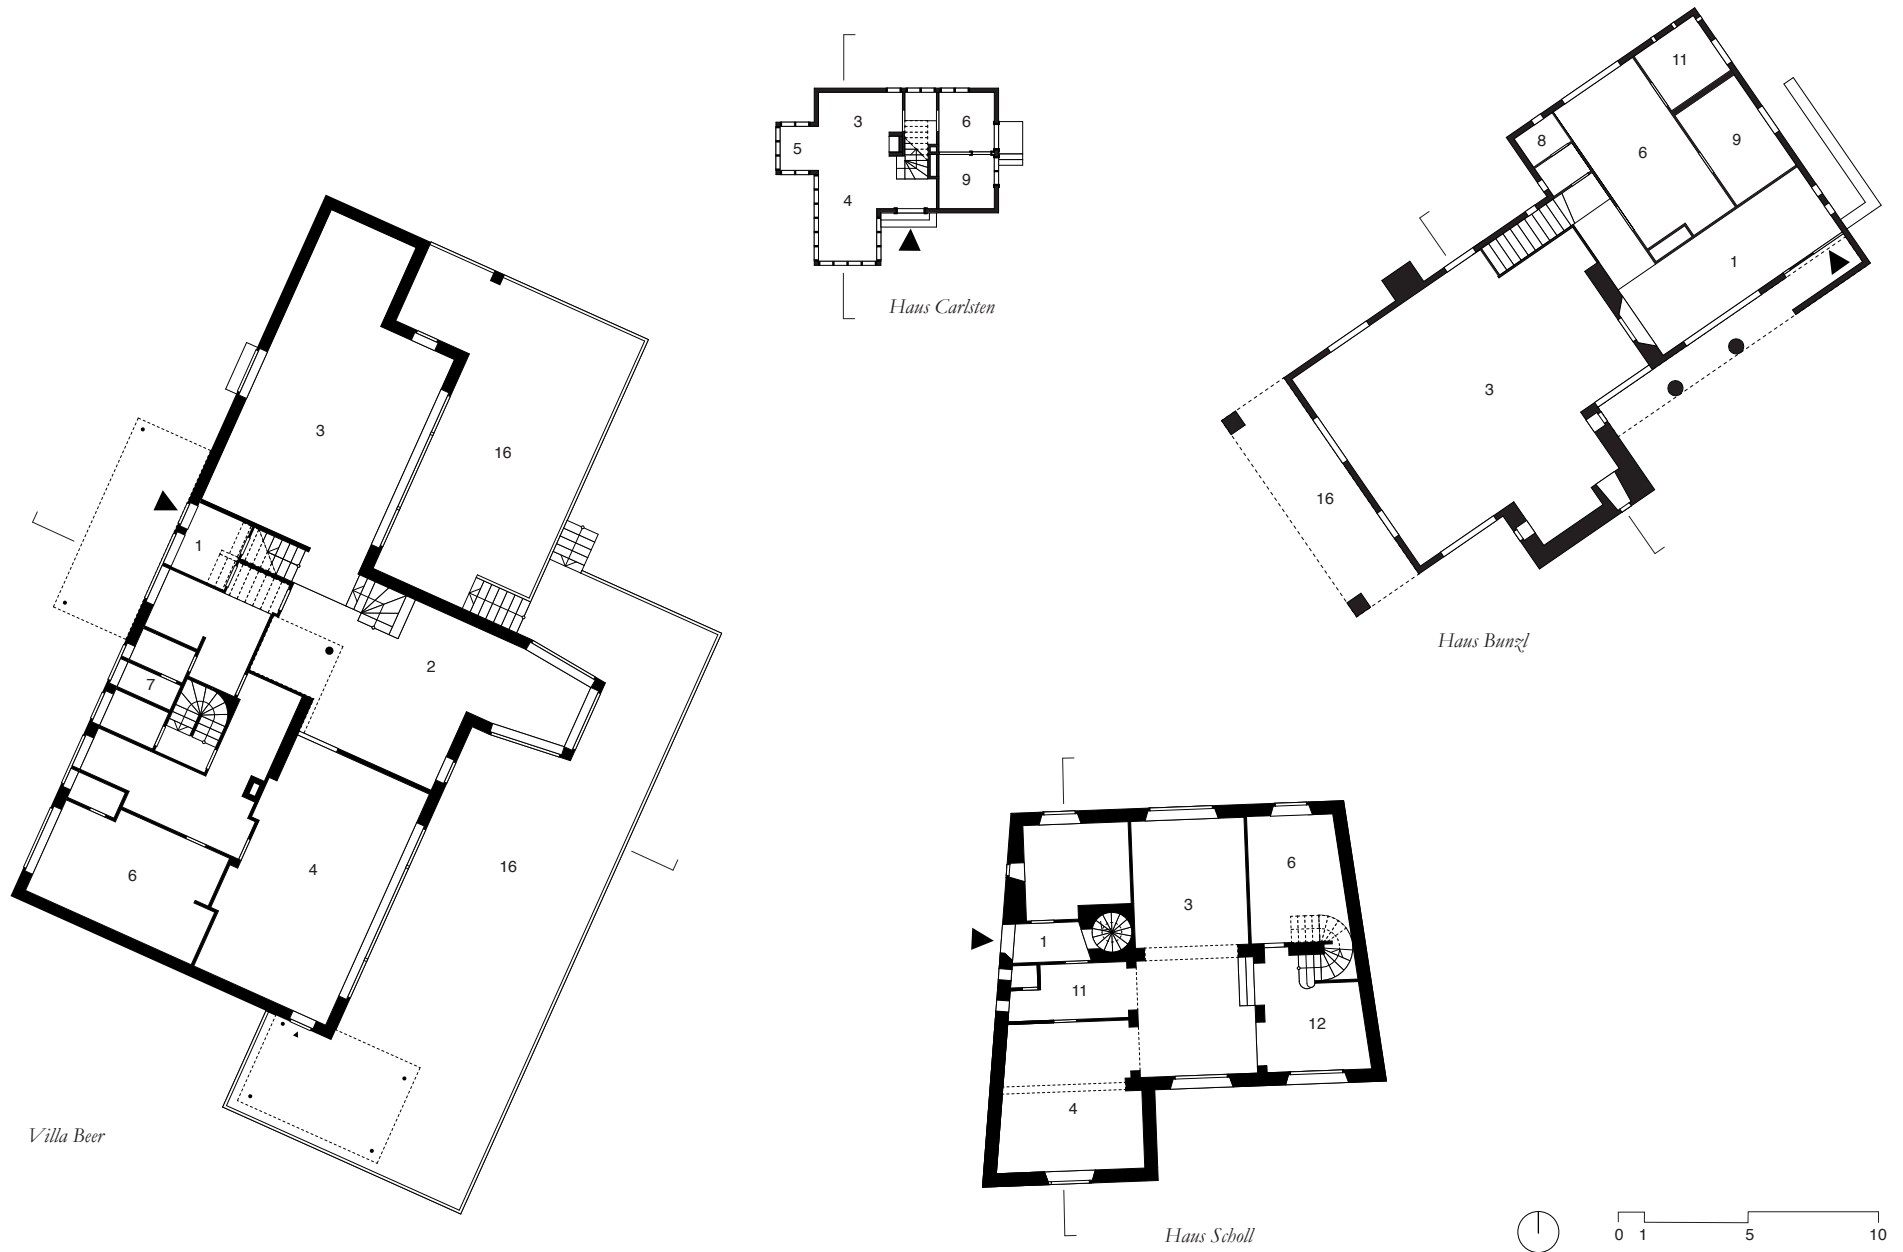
Vier Grundrisse Erdgeschoß
